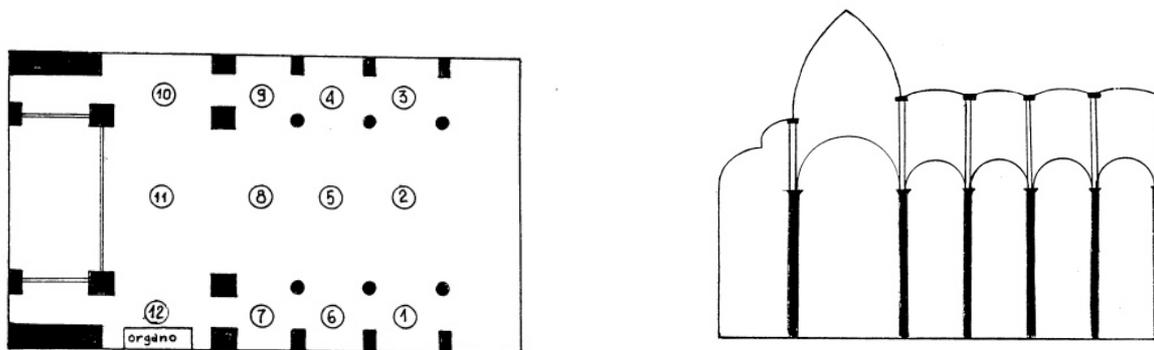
Planimetria e sezione del Santuario di Santa Rita in Torino. Nella planimetria sono indicati i punti di misura dell'indice STIPA
